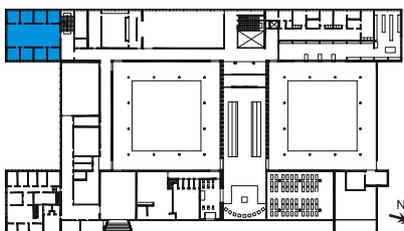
Localização do Noviciado. Primeiro Pavimento. Obra construída. (Desenho da autora).
